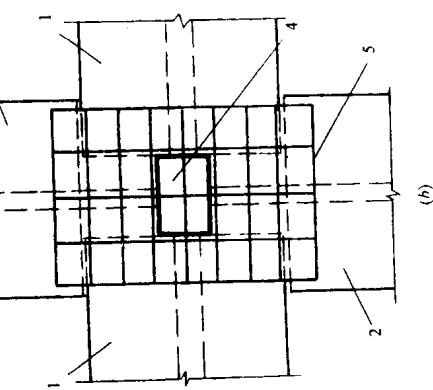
楼板上层钢筋焊接网与柱的连接 (二)
